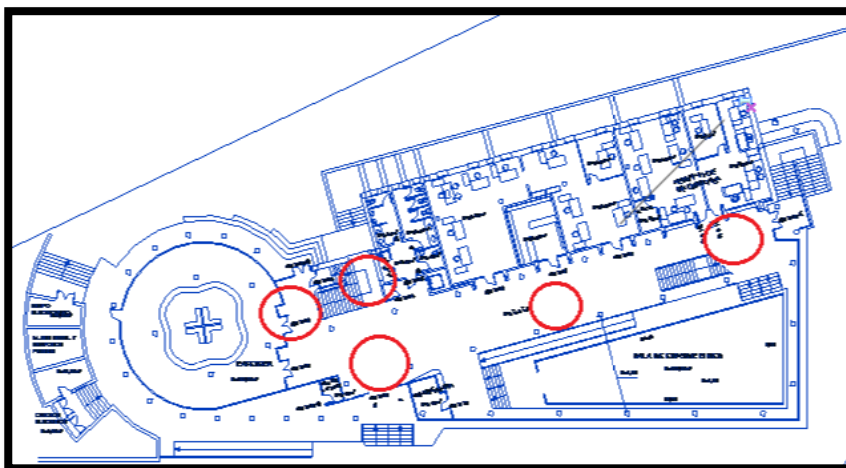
Zonas propuestas del láser escáner en la Planta Baja.
